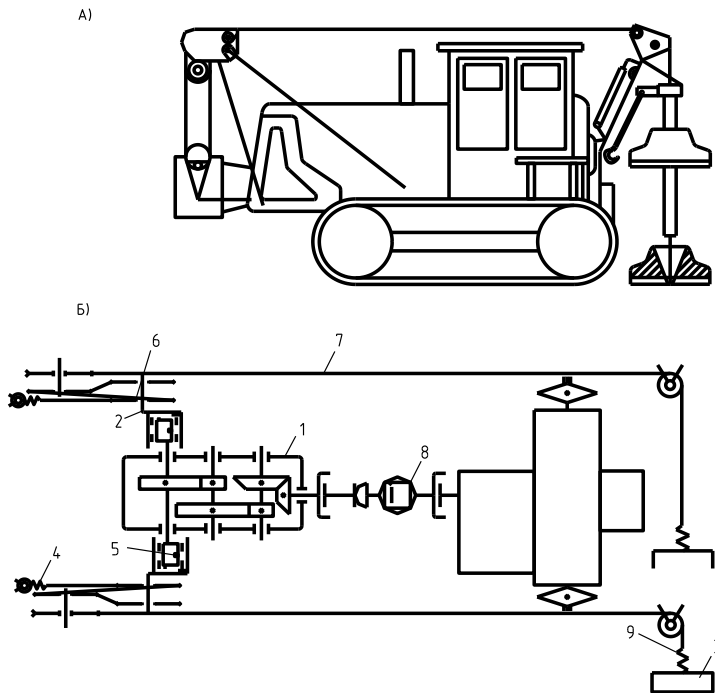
Трамбующая машина на базе гусеничного трактора (А); Б – кинематическая схема привода рабочего оборудования
